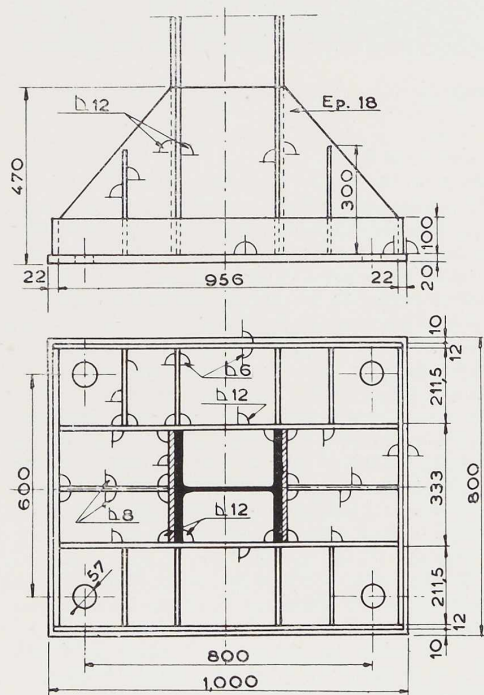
et 47. Détails de construction d'un pied de colonne.
